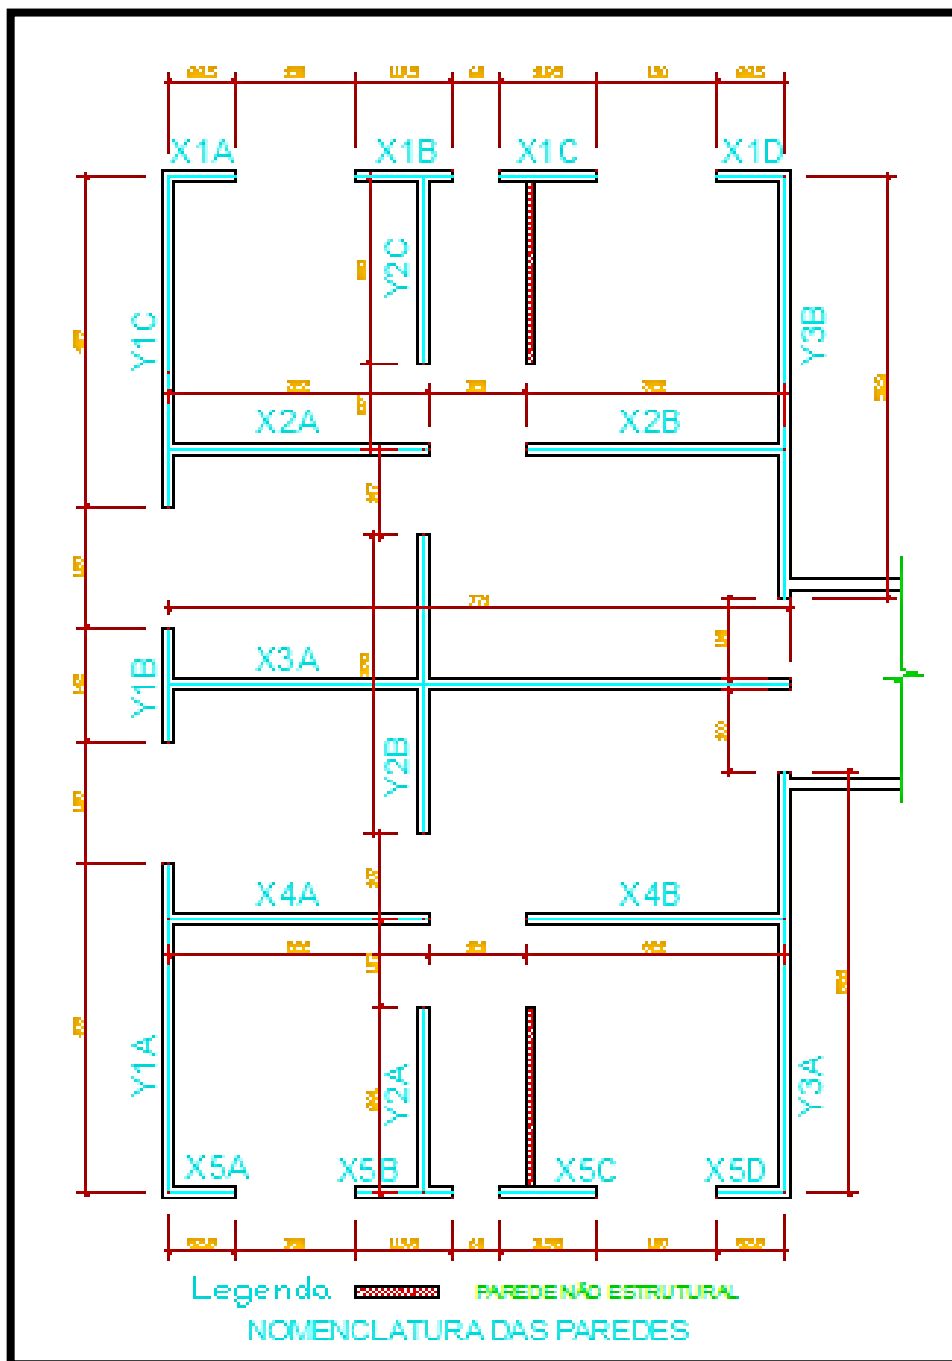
Planta baixa do pavimento tipo com nomenclatura das paredes isoladas
